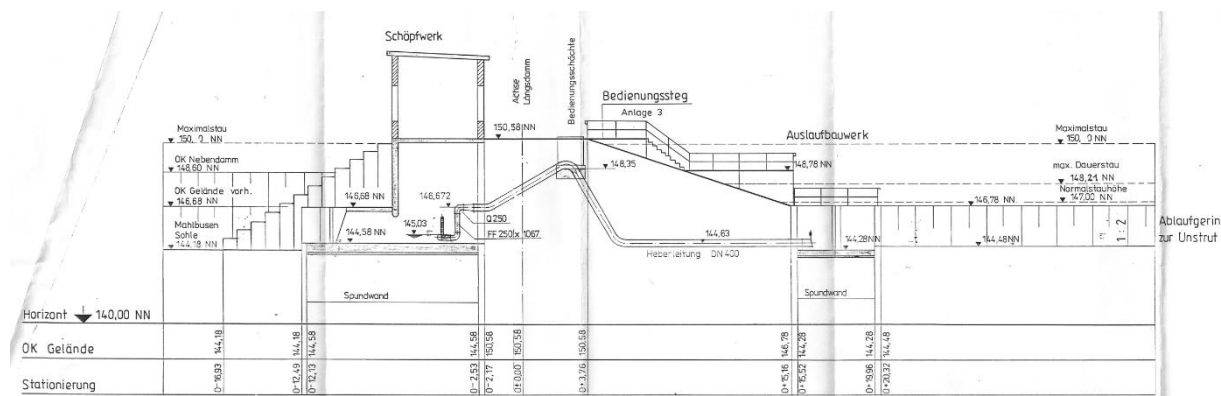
Auszug aus dem Plan 5.2/1 „Lageplan 2 – Heberleitung“
